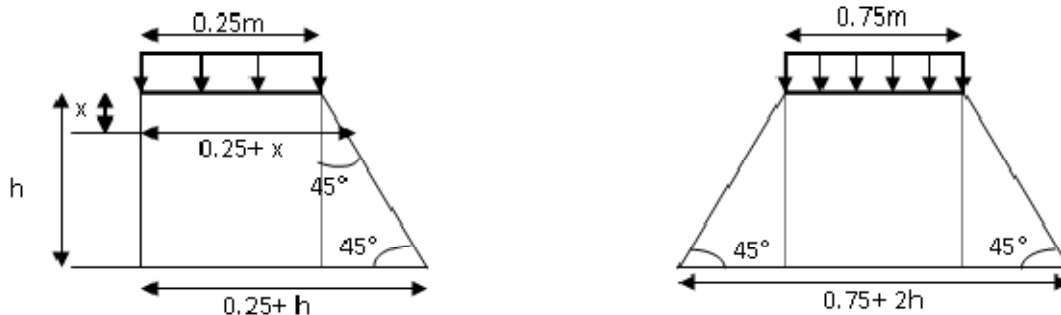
Poussée de la charge locale située en arrière de mur
